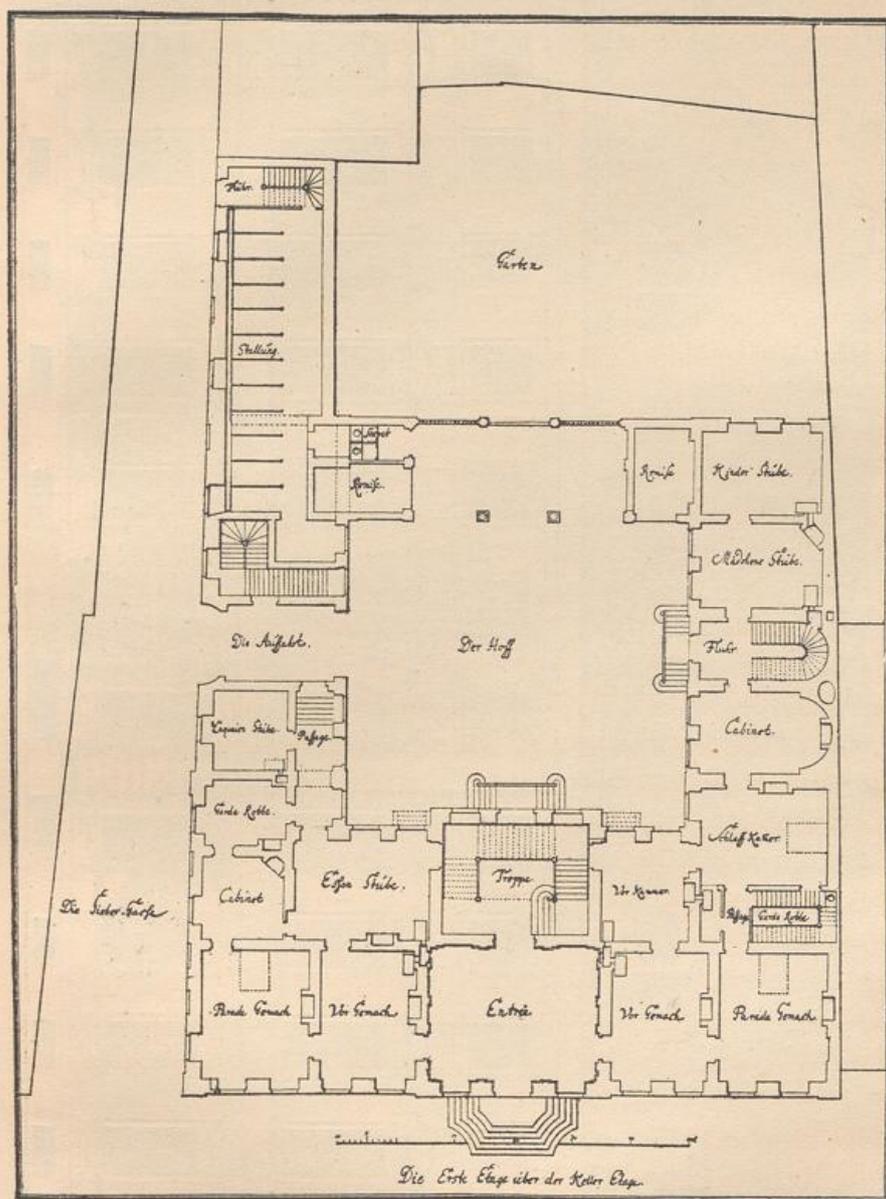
Kreuz'sches Palais zu Berlin. Nach einem alten Plan. 164)
